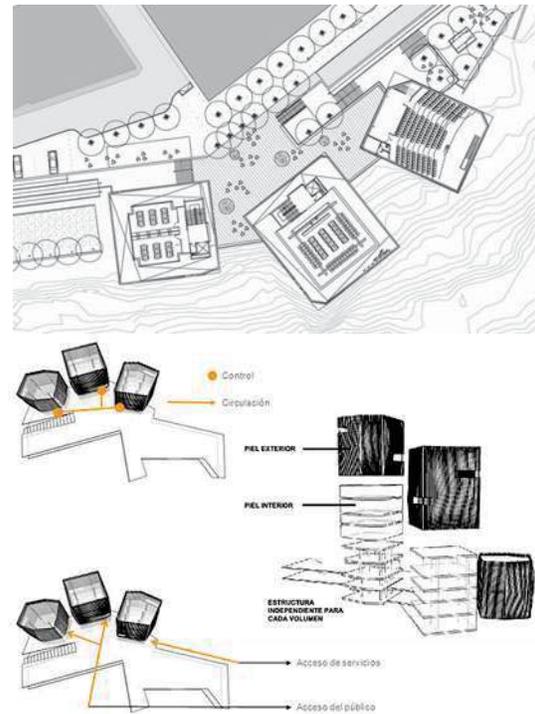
Planta y Alzado de Biblioteca Parque España, Cd. Santo Domingo, Colombia Bogotá, ARQ. / GIANCARLO MAZZANTI.
